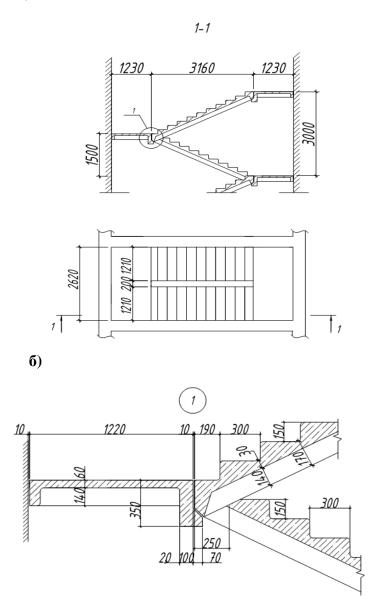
Детали сборной железобетонной двухмаршевой лестницы: а- марш; б- детали узла
